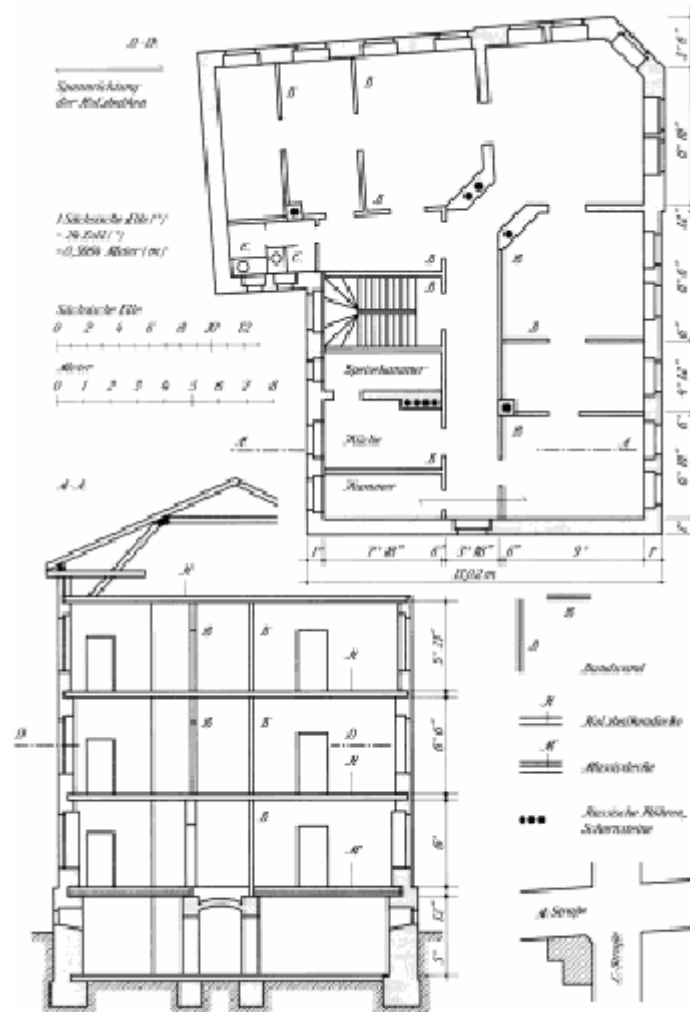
Schéma d'un bâtiment de construction traditionnelle (1860), de Leipzig (Allemagne). Ce type de construction est également représentatif des constructions de l'époque en Suisse.
